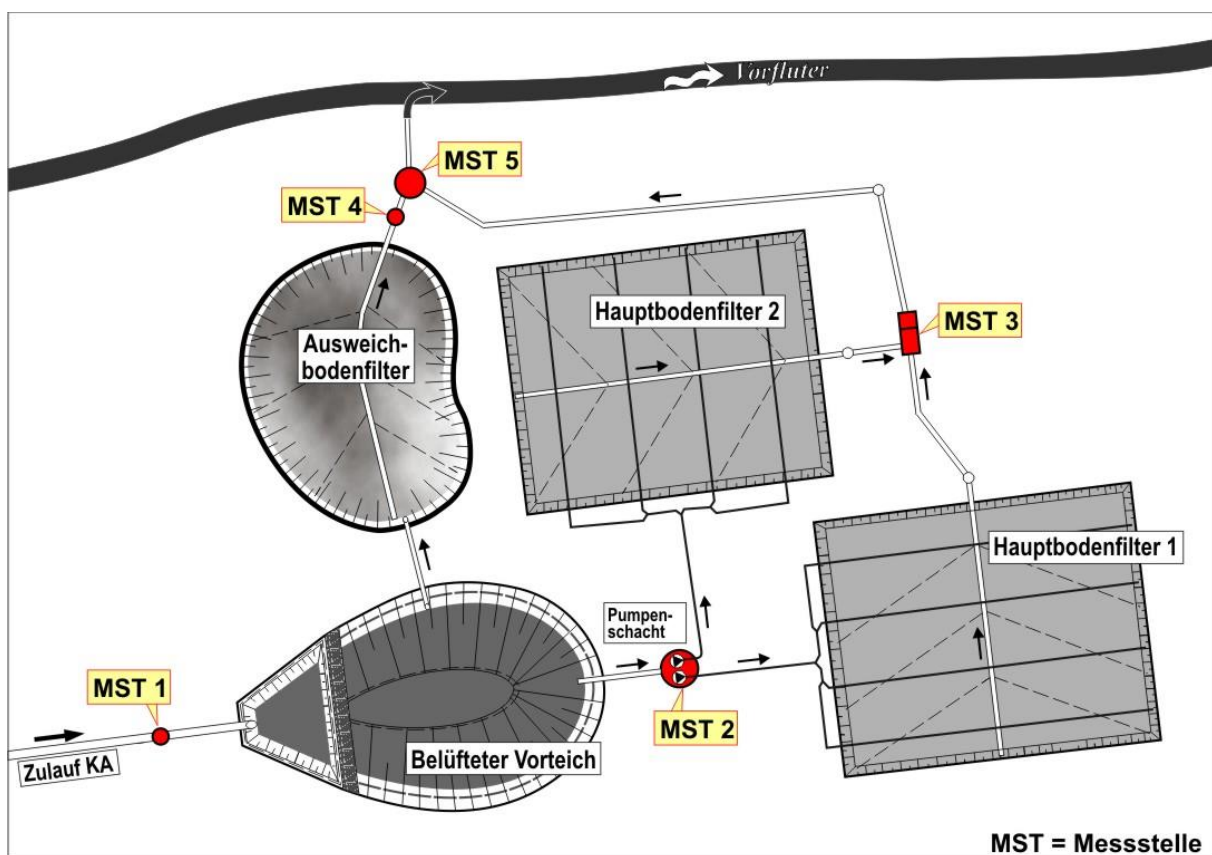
Lageplan zur KA Büschdorf mit Mess- und Probenahmestellen
